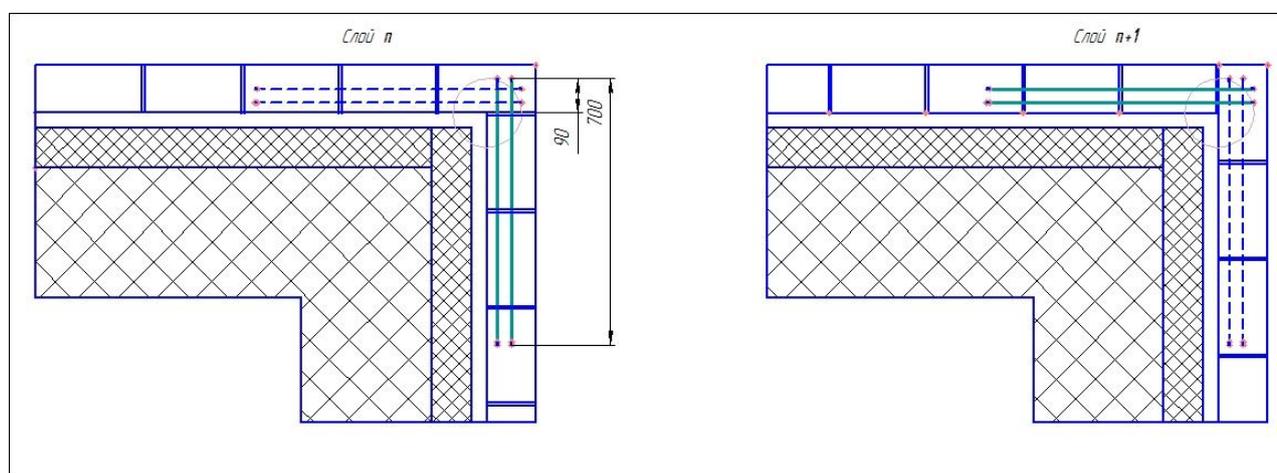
Пример армирования углов облицовочного слоя стеклопластиковыми стержнями (арматурой).
